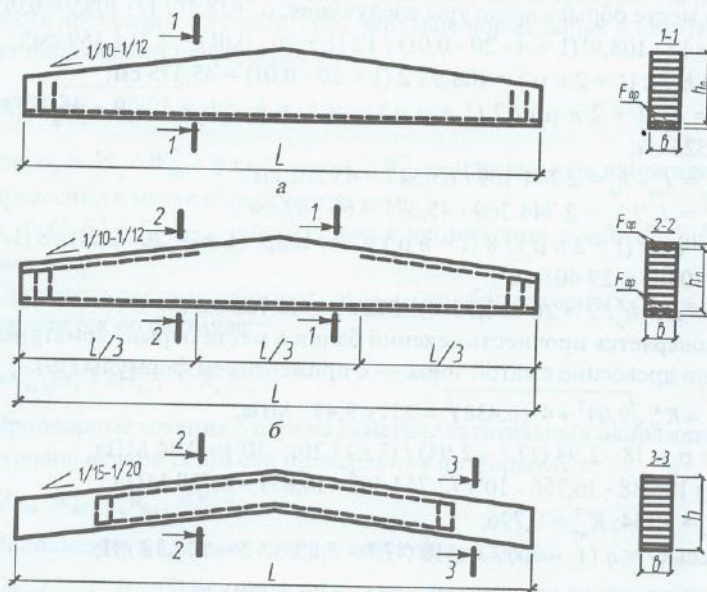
Клееные армированные двускатные балки: а — с одиночным армированием; б — с двойным симметричным армированием; в — с двойным симметричным армированием на части пролета
